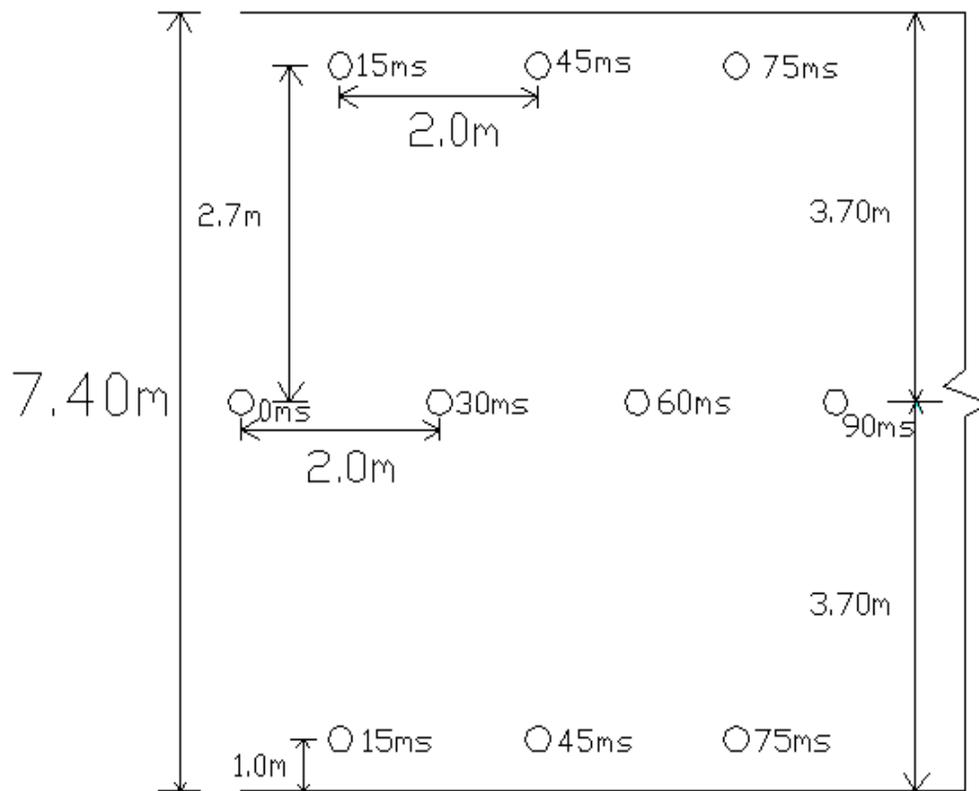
Vista en planta del esquema de voladura del canal. Fuente: Autor, (2019).
